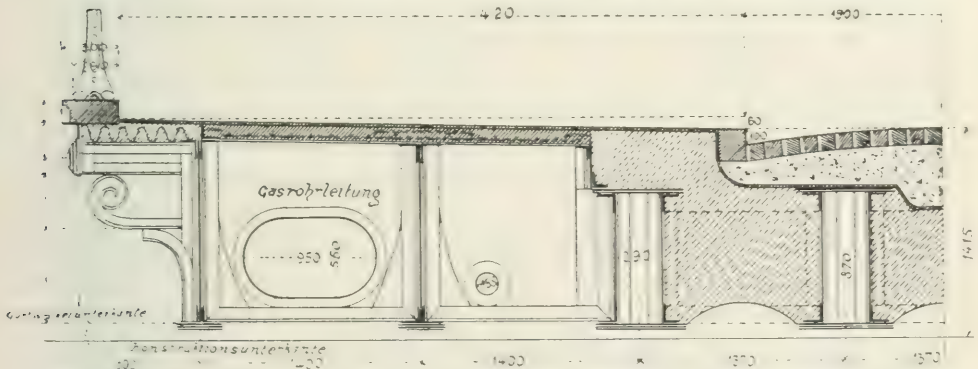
Überbrückung der Wiener Stadtbahn im Zuge der Landstraßer Hauptstraße.
